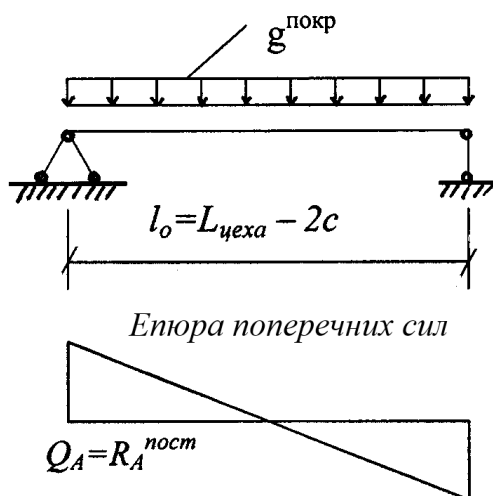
Розрахункова схема кроквяної конструкції при визначенні опорної реакції R_A
